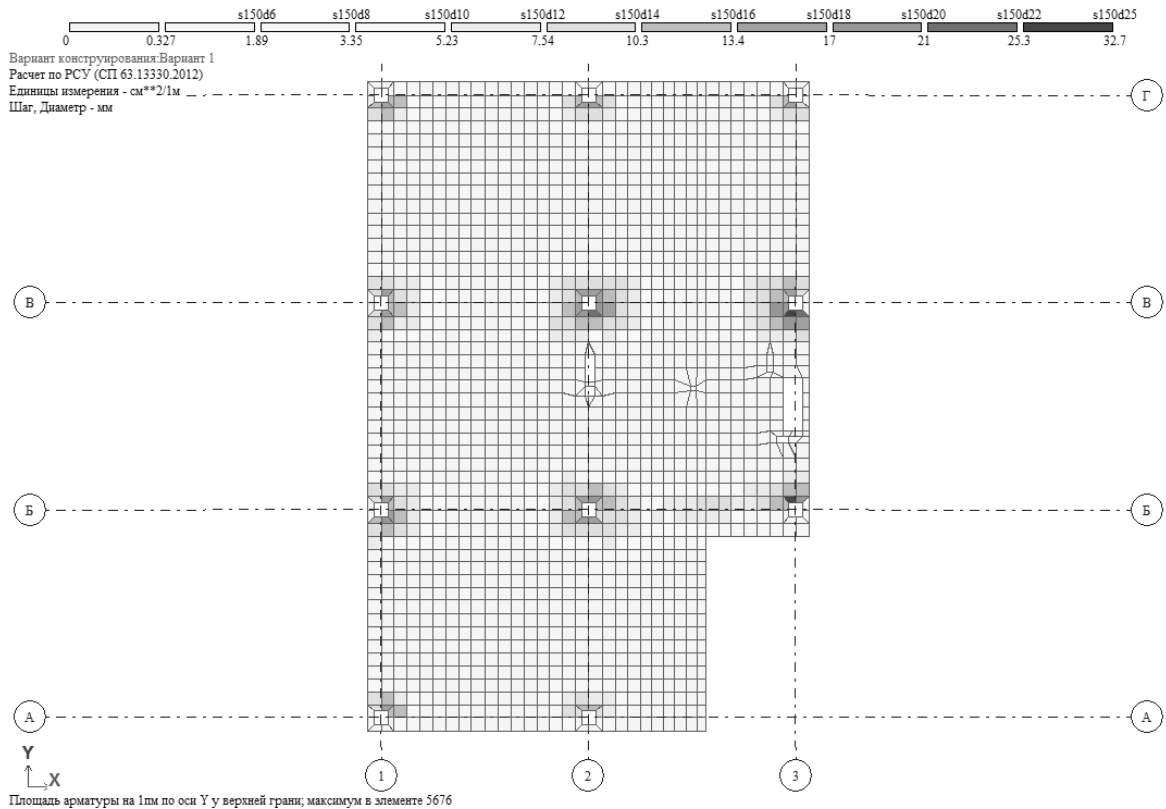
Армирование плит перекрытия по оси Y у верхней грани
